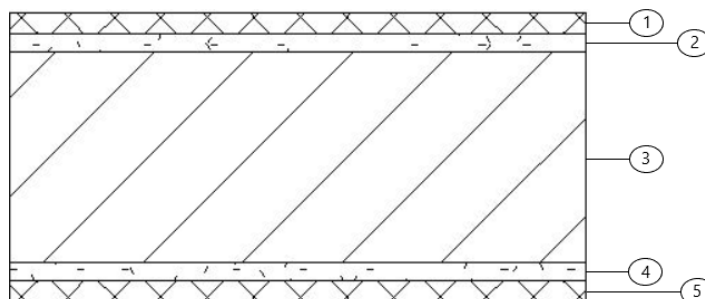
Pormenor da constituição da parede interna tipo I2
